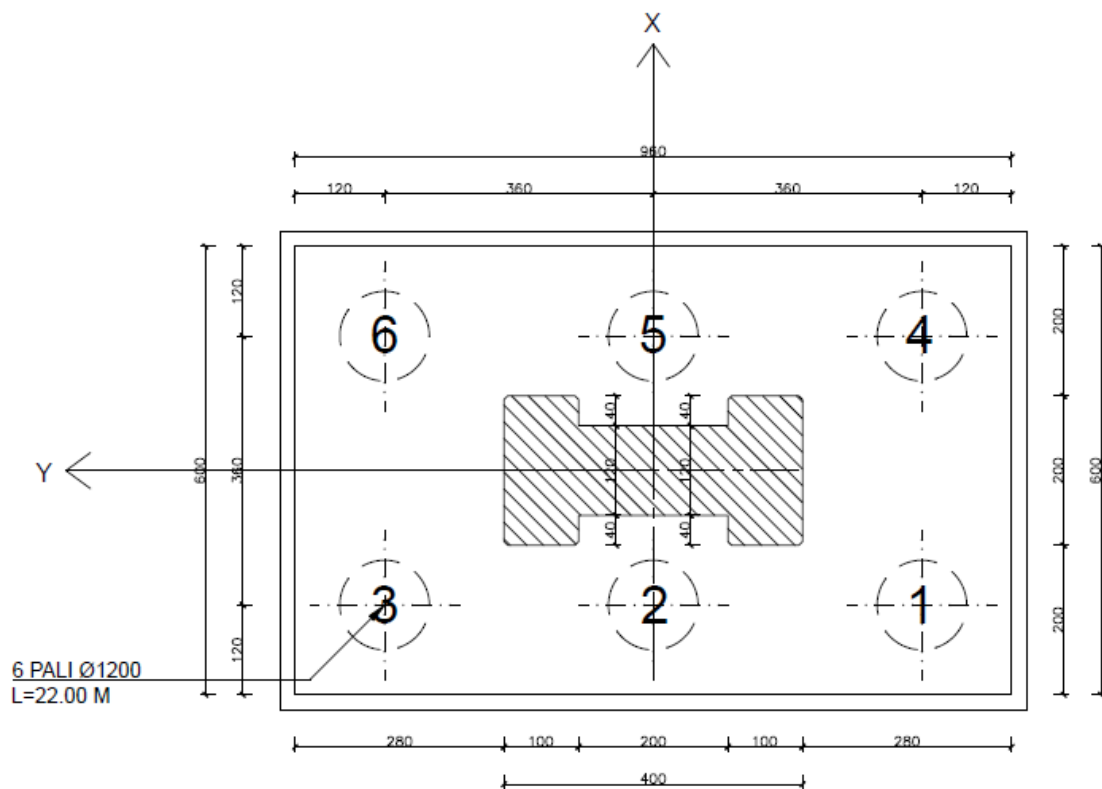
Numerazione pali del plinto di fondazione delle pile
